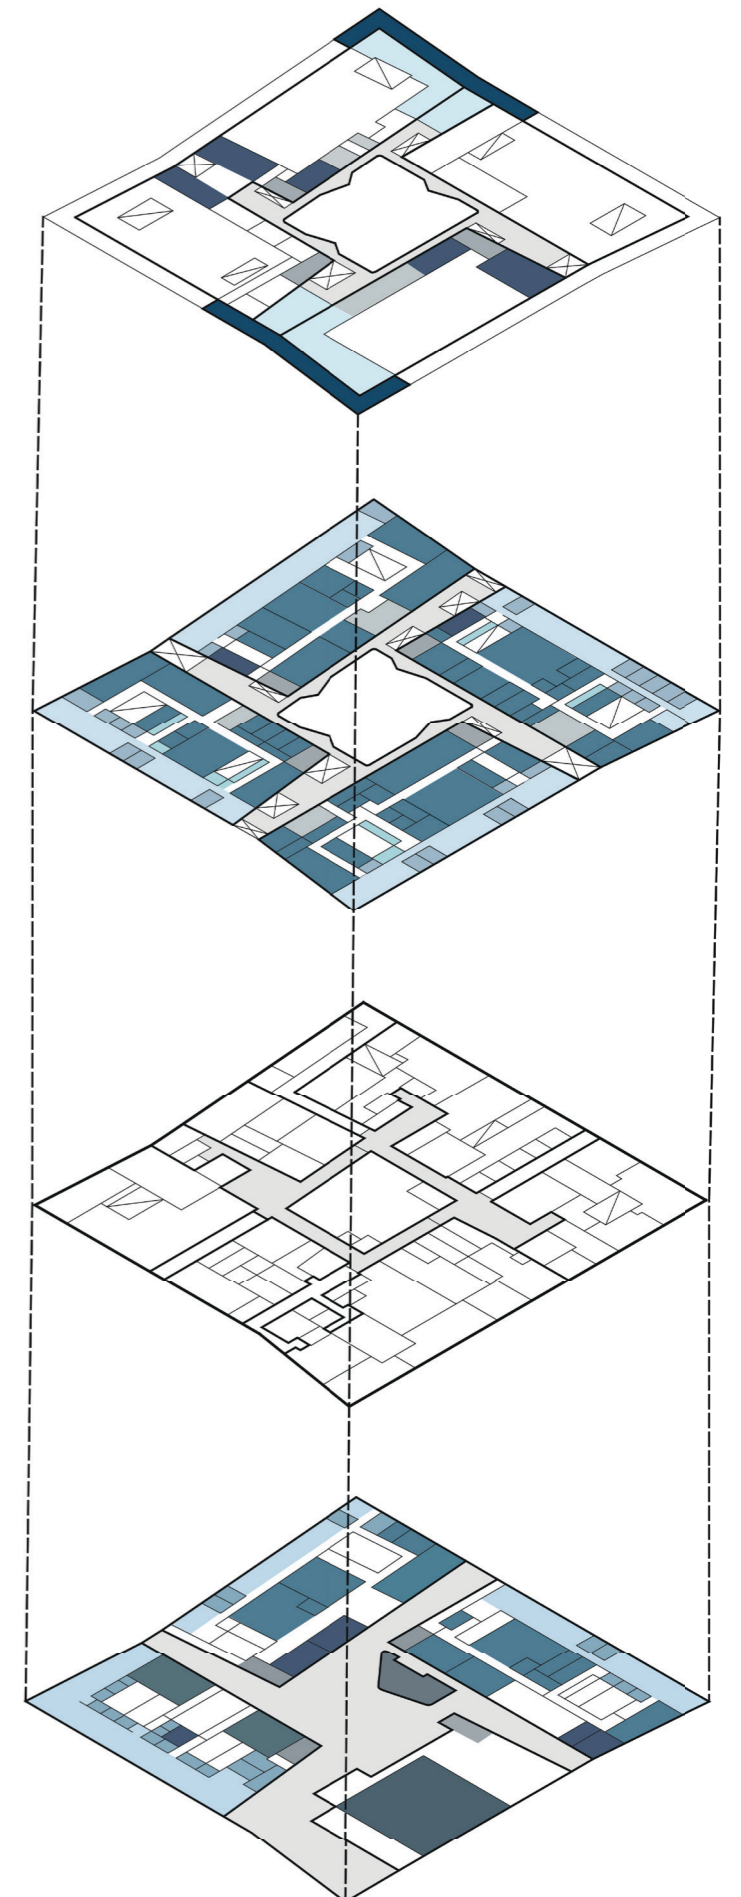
Planimetrie dei vari piani di Biomedicum. Elaborato ZA, 2022.
